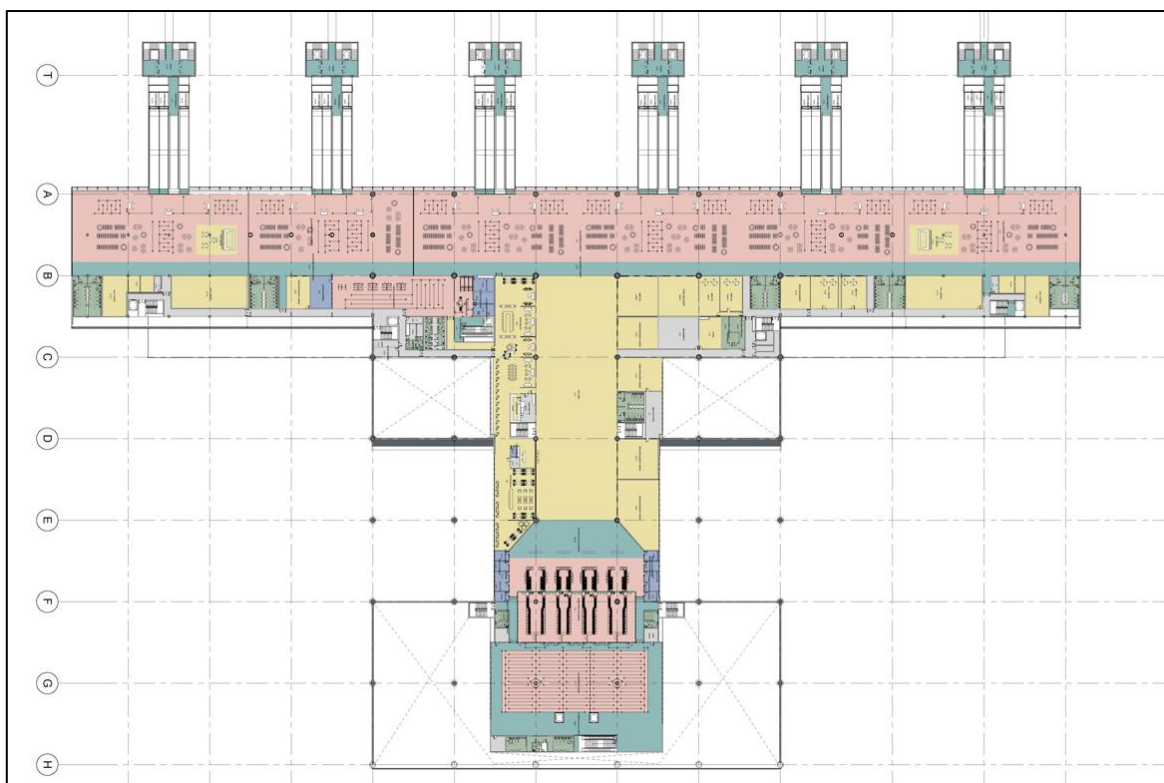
| Planimetria Piano Primo 2035– Zoning delle aree
